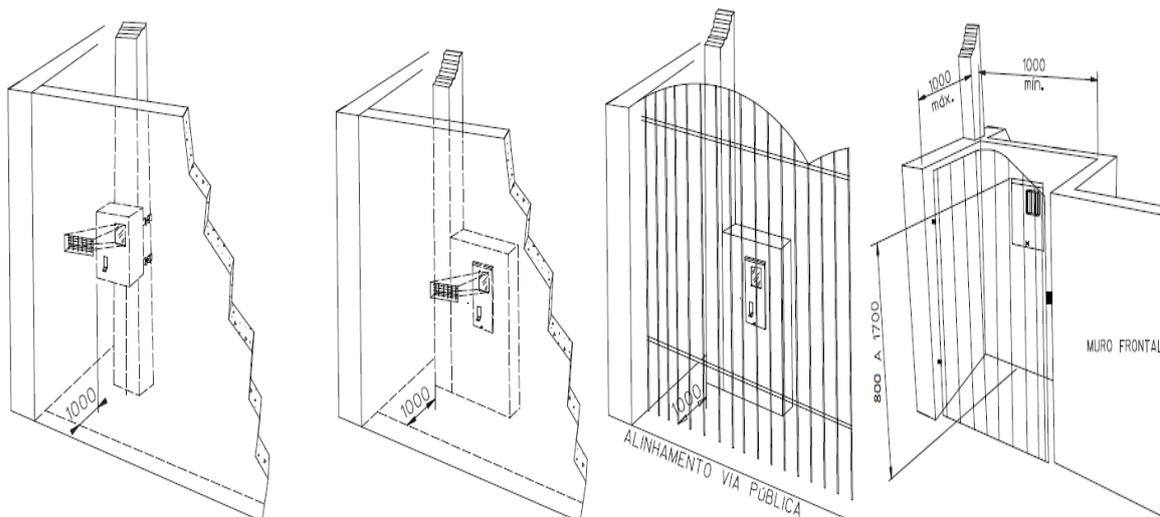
E.S. Tipo Muro Frontal (Ramal fixado na fachada)
